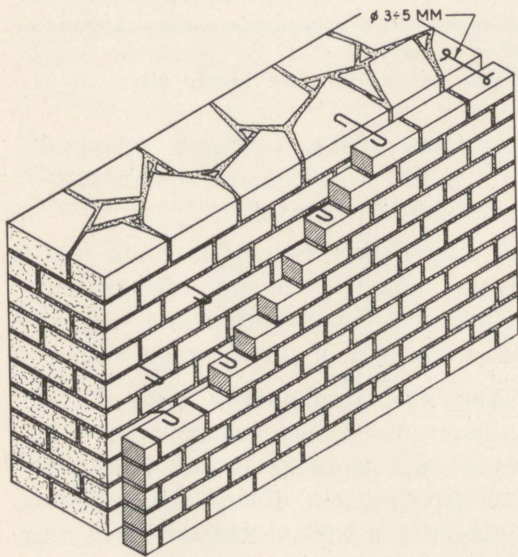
Облицовка плитняковой стены кирпичем. Облицовка анкерована оцинкованными анкерами из 3—5 мм железа (около 8 шт. на м²).
